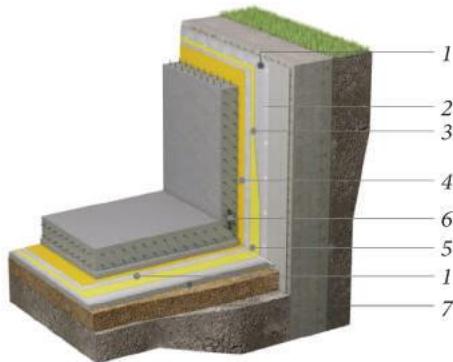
Система *ТН-ФУНДАМЕНТ Барьер Стена в грунте*:
